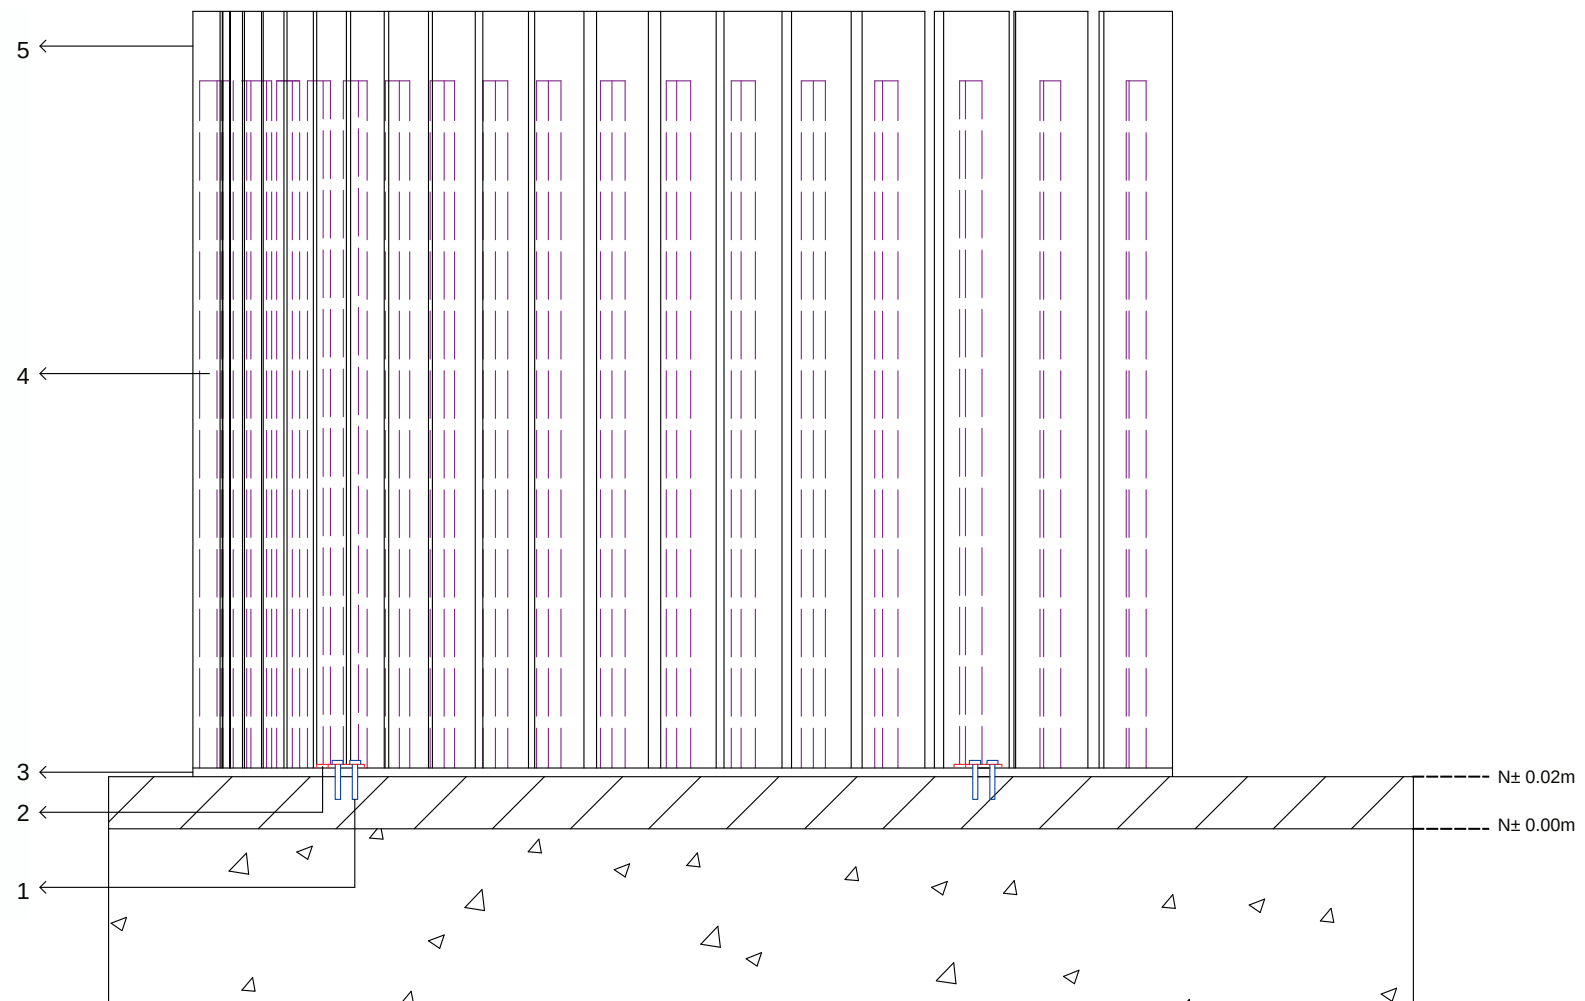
Detalle constructivo de soporte metálico para anclaje de listones de madera
